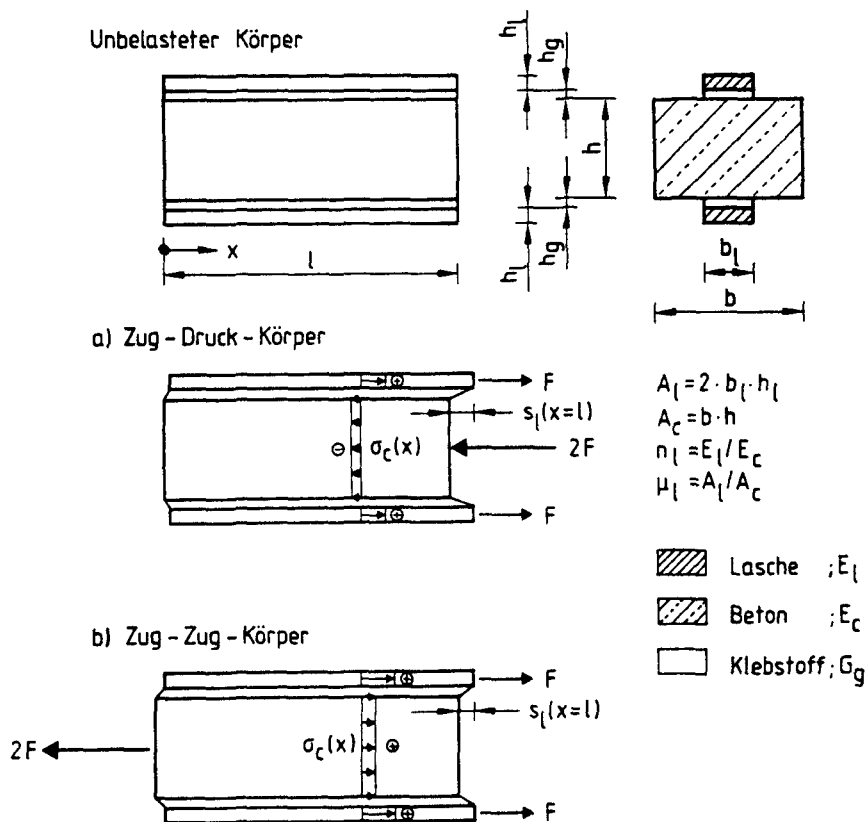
Betonkörper mit geklebter Bewehrung (schematisch)
